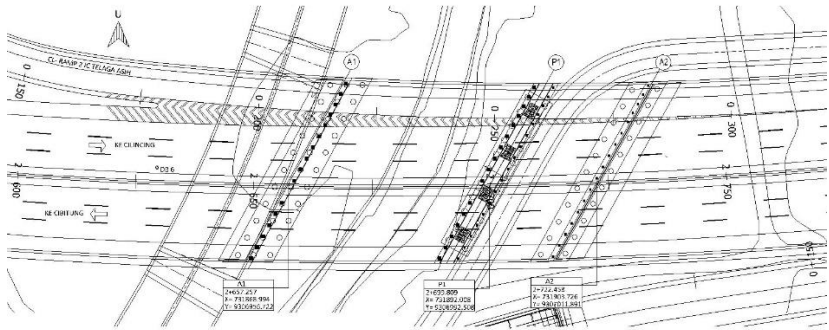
Peta Layout Jembatan Sadang 1
